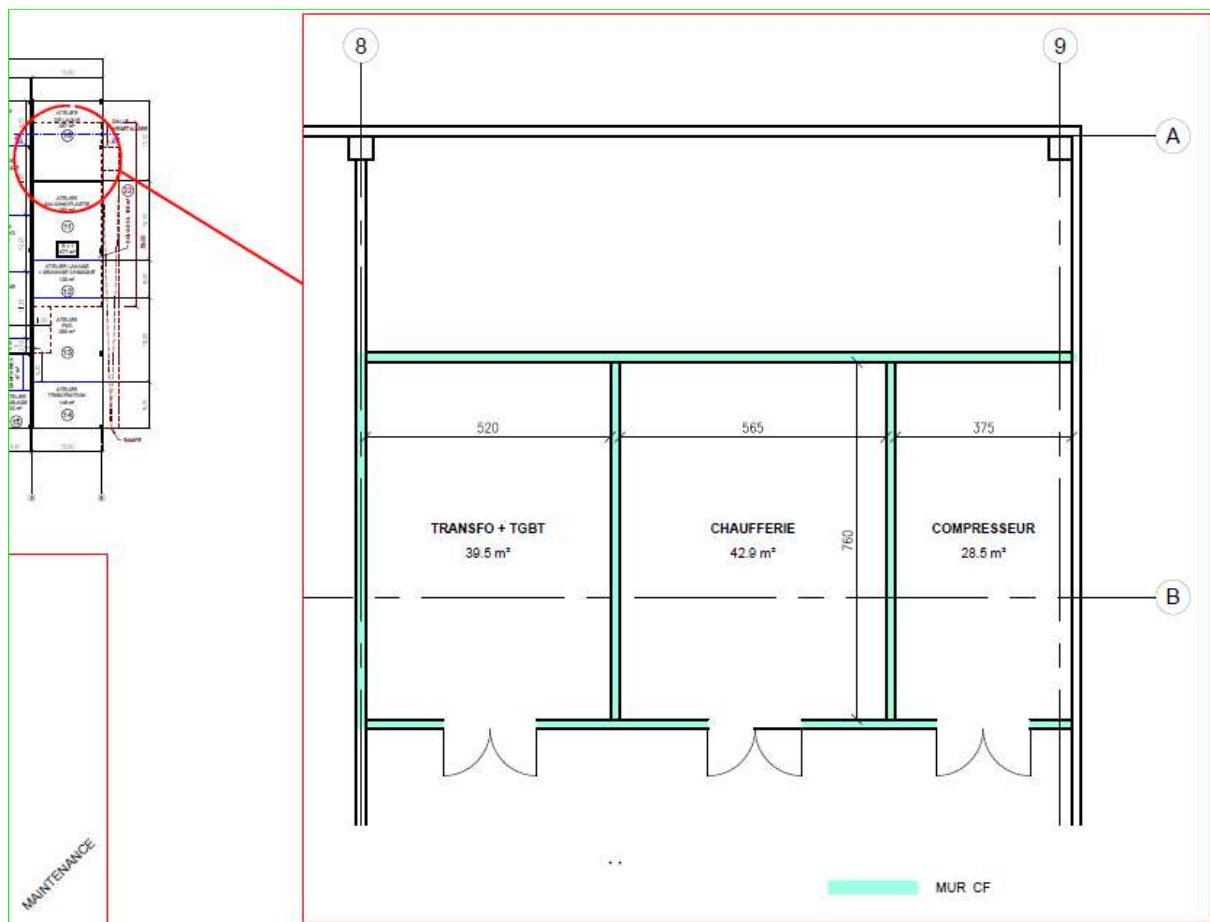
PAROIS REI 120 – LOCAUX TECHNIQUES AU SOUS-SOL
